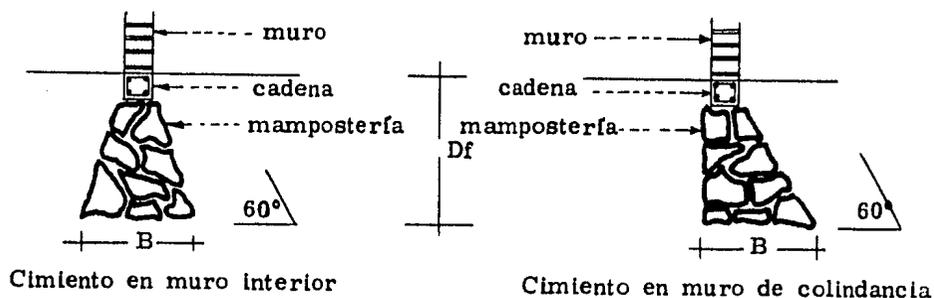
CIMENTOS DE MAMPOSTERIA.
